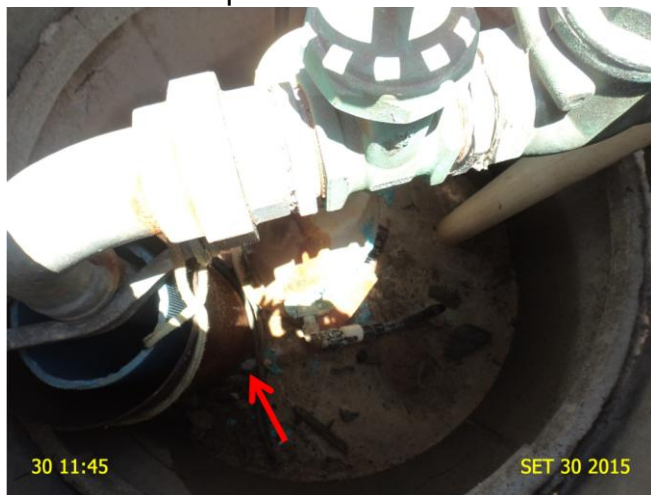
Poço do Riacho Doce: ausência de laje de proteção.
